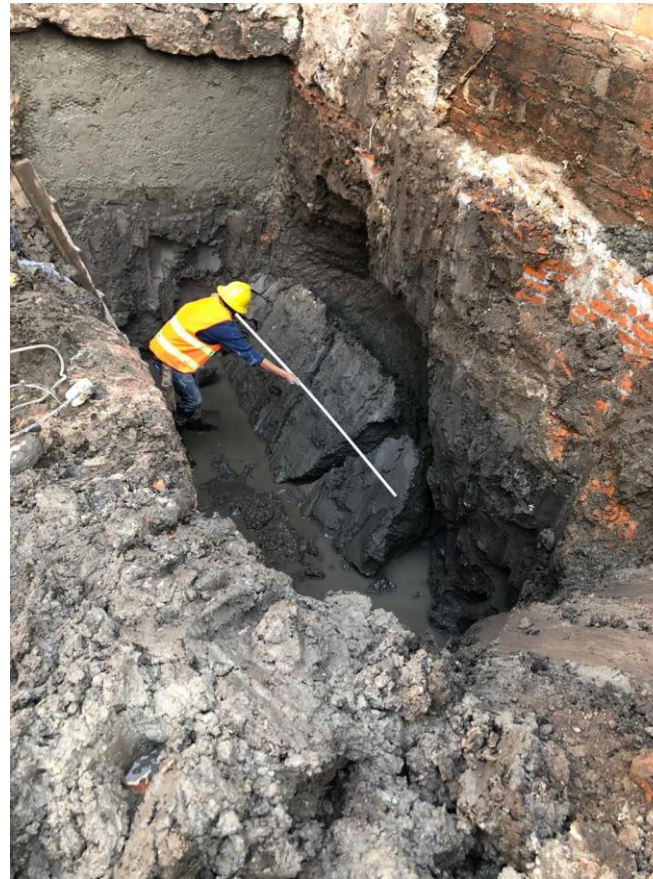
Derrumbe por debajo de la cimentación colindante.
